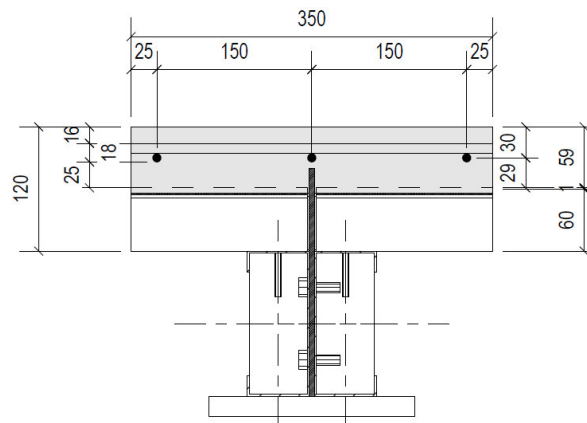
Disposição transversal da armadura realizada no *Software Tekla Structural*.
